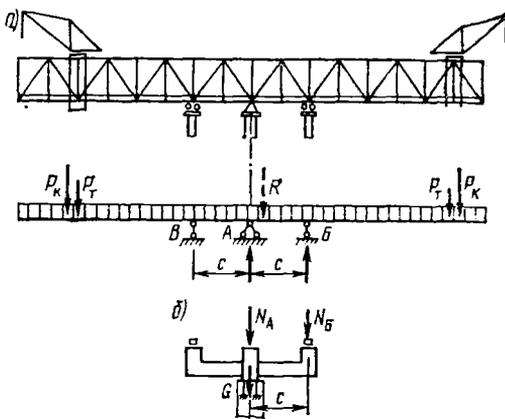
Расчетная схема стального пролетного строения и опорных устройств при уравновешенной навесной сборке
